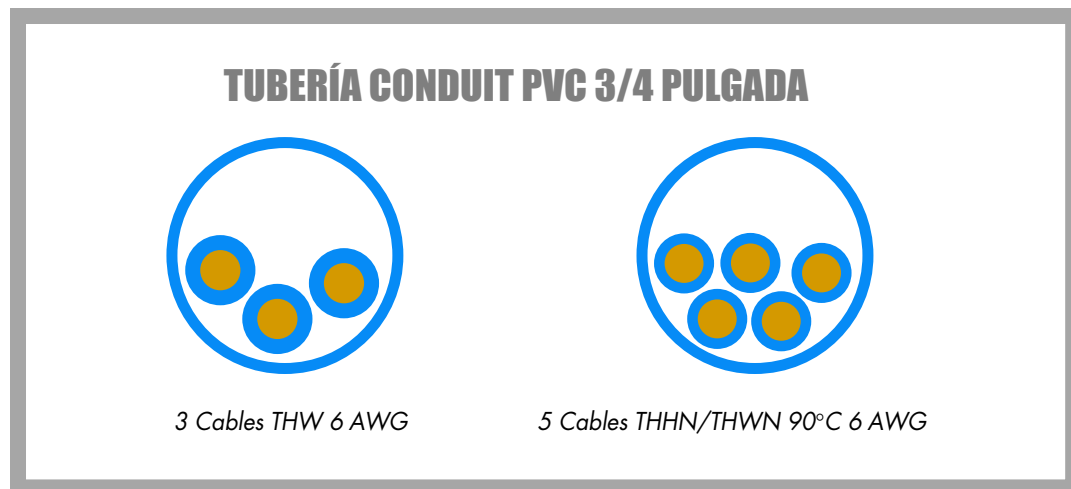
Capacidad en tubería conduit PVC 3/4 pulgada (dibujo a escala).
